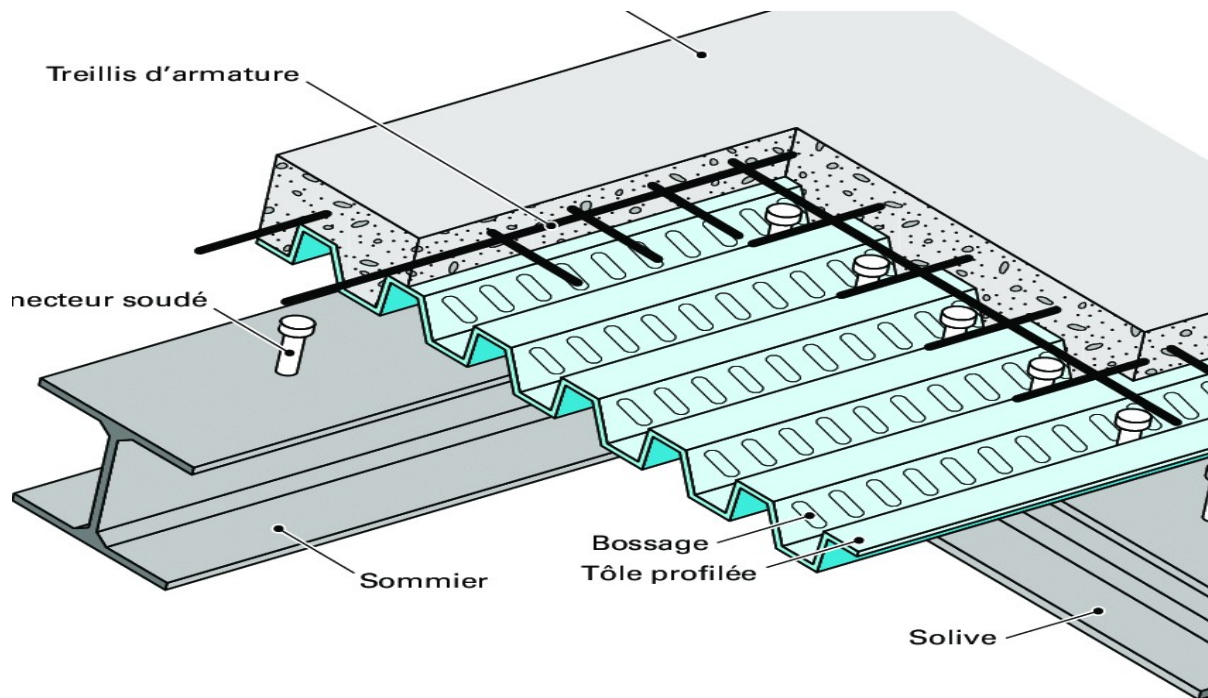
Eléments constructifs d'un plancher mixte (CRISINEL MICHEL, conception et calcul des dalles mixte)
